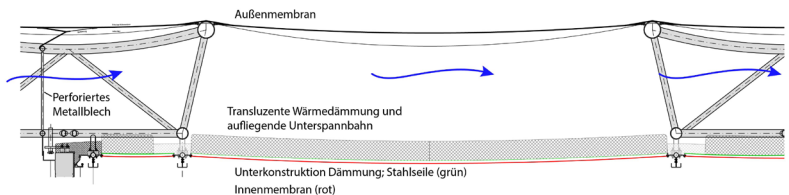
Detailschnitt durch die Fachwerkträger und den Membrandachraum
